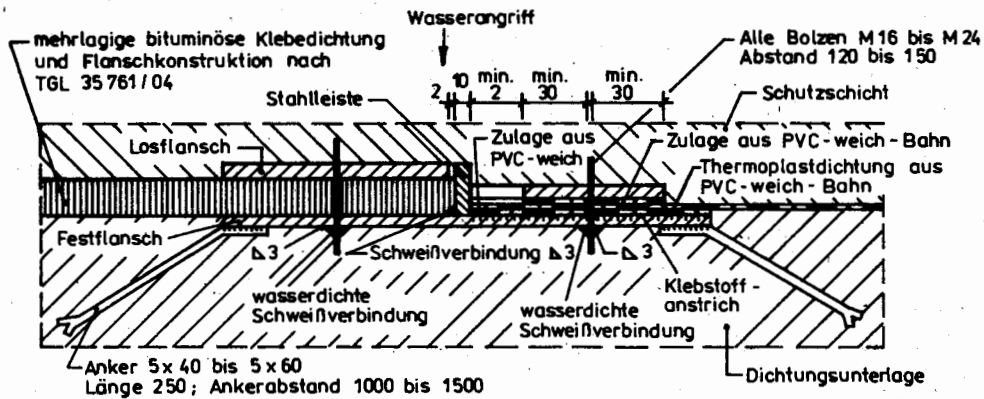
Übergang von der druckwasserhaltenden bituminösen zur PVC-weich-Dichtung durch Flanschverbindung
